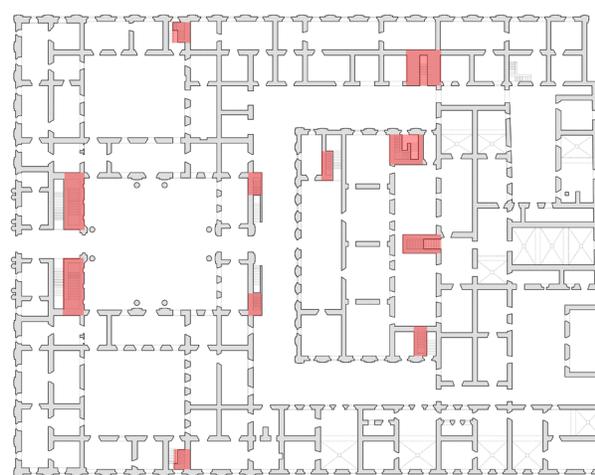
Núcleos rígidos en planta Palacio de la Moneda. Elaboración propia.
